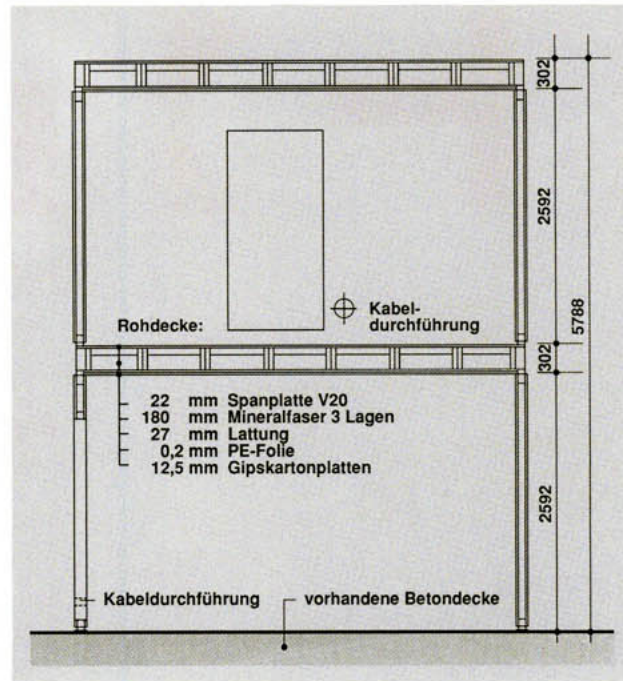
Schnitt durch den Prüfstand (alle Maße in mm)
